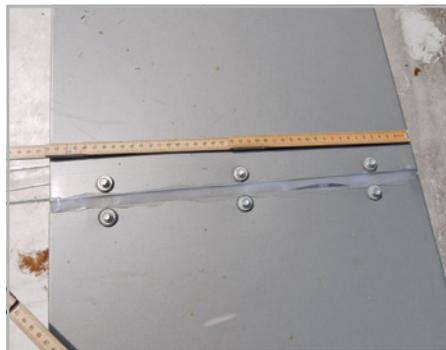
(li) Selbsttragende verdeckt befestigte Abdeckung, jedoch mit Neigung nach außen und Wasserläufern an der Fassade.
